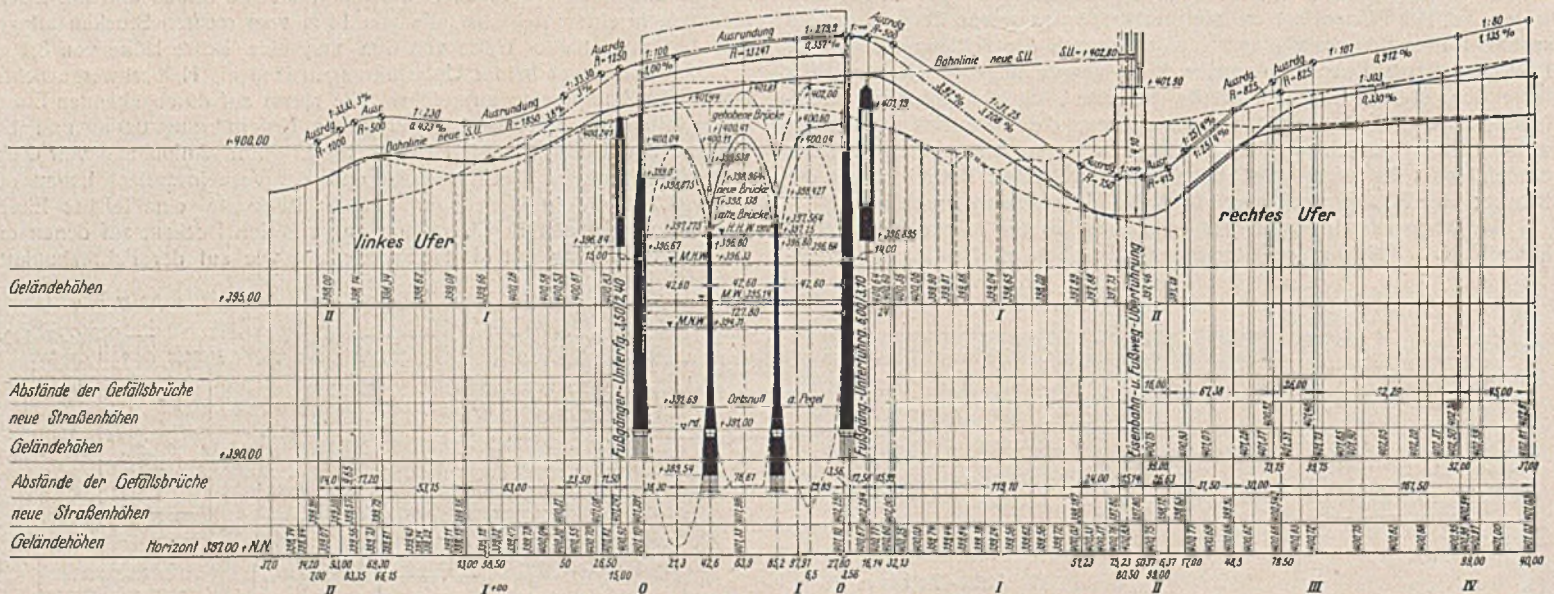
Längsschnitt der Straßenbrücke mit Zufahrtsrampen.
